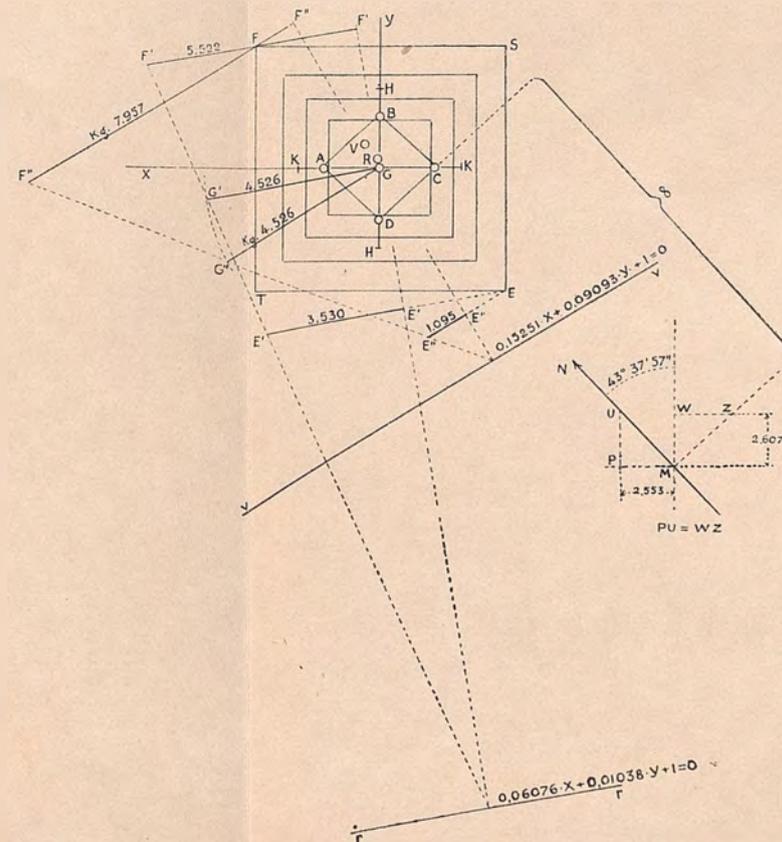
Sezione III a m. 2,90 dalla II (piano pavimento).
